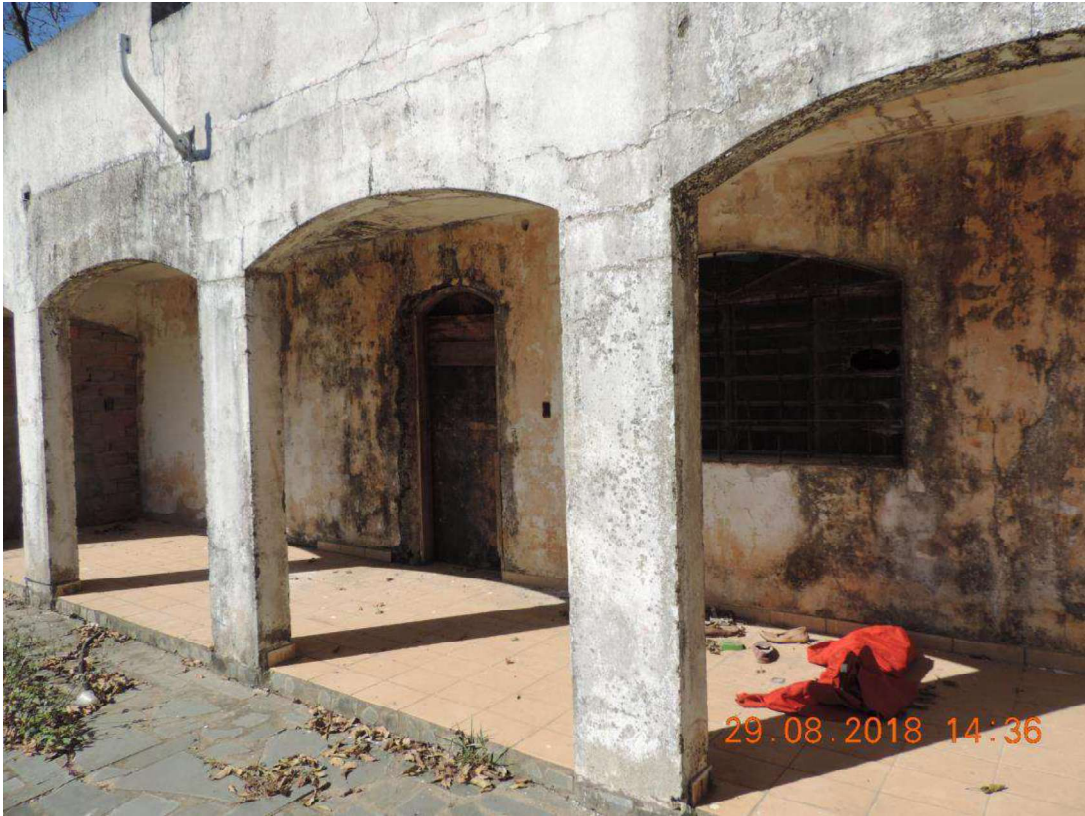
VISTA EXTERNA DA “CASA DE HÓSPEDES”
